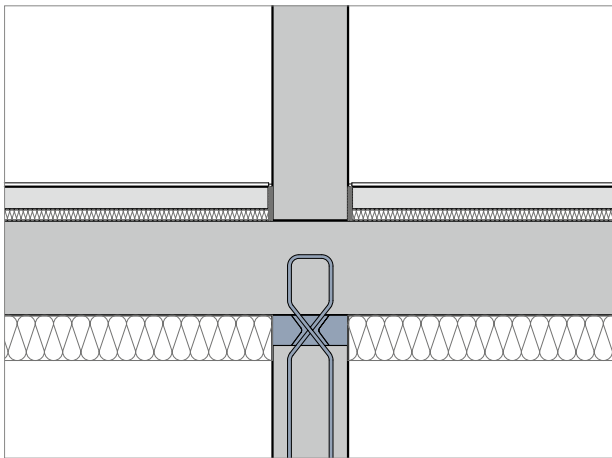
Schöck Sconnex® Typ W bei Innenwand und Unterdeckendämmung
